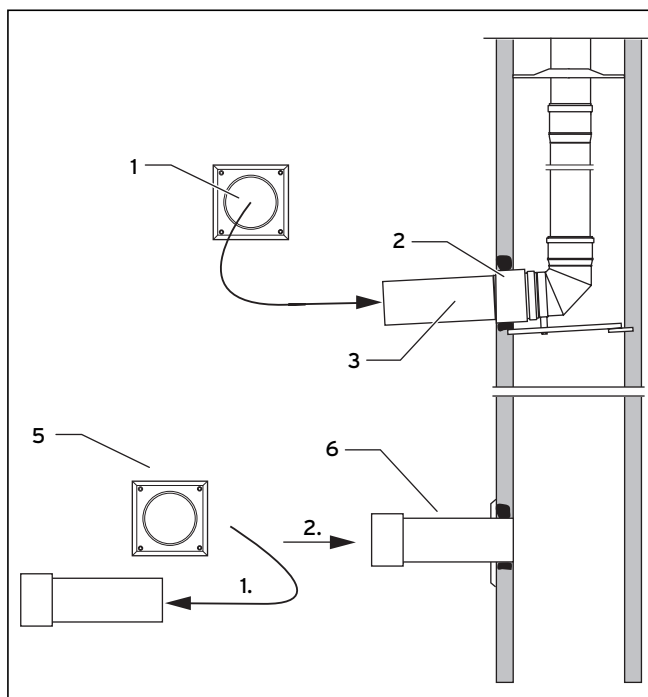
Montage du conduit de fumées, du tuyau protection, du cache et du conduit d'air de combustion
